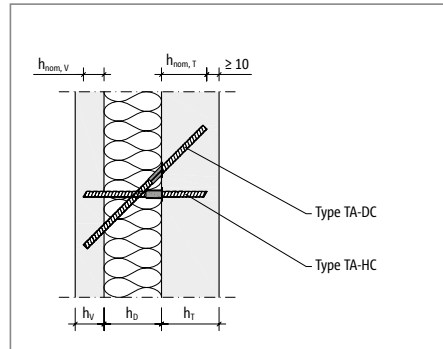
Schöck Isolink® type TA-HC, TA-DC: Cross-section details for the sandwich wall;  $h_{nom,V} < h_v$
